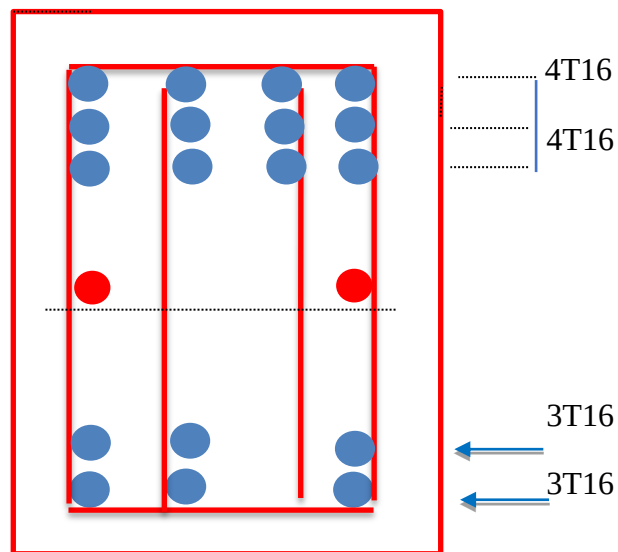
Ferrailage de la poutre de libage (sens longitudinale)
